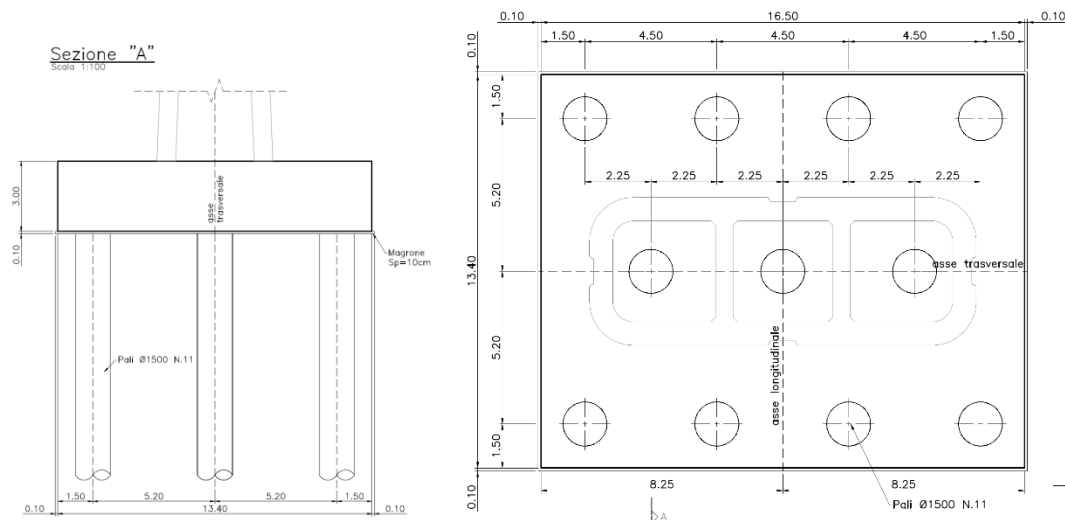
stralcio della carpenteria pila e fondazione su n° 11 pali
